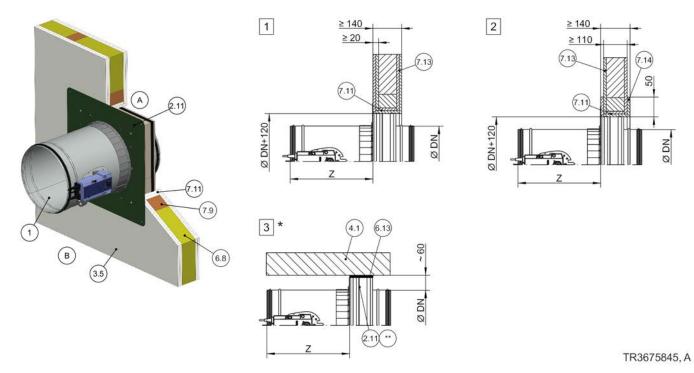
Montagem seca numa parede divisória leve com estrutura em enxaimel, usando kit de montagem quadrado TQ
